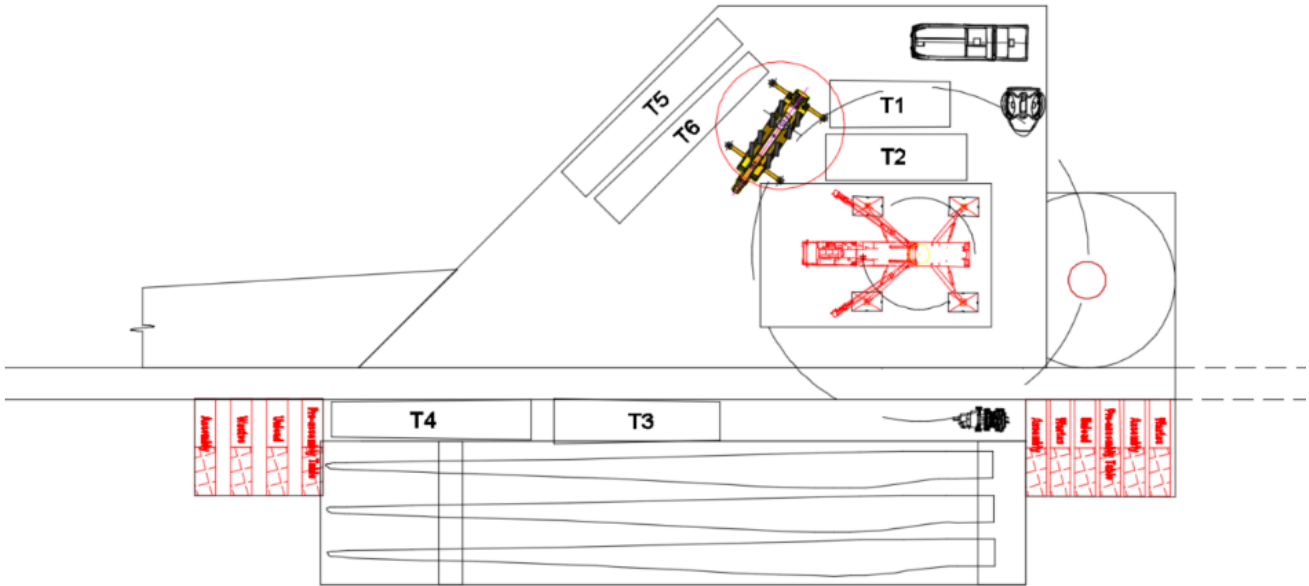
Tipico Piazzola di Cantiere durante la Prima Fase di Montaggio
